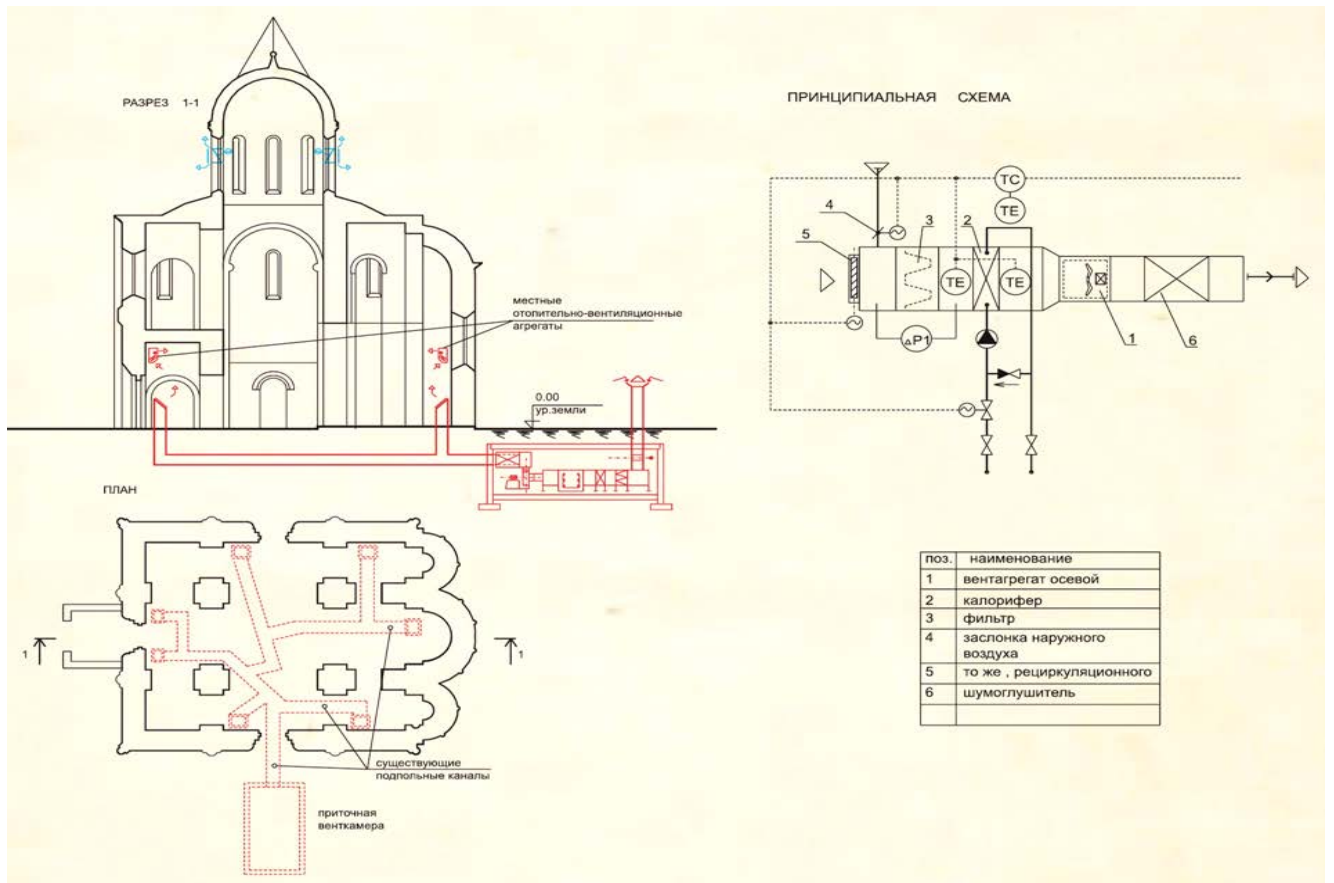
Собор Рождества Богородицы в г. Суздале. Воздушное отопление, совмещенное с вентиляцией
